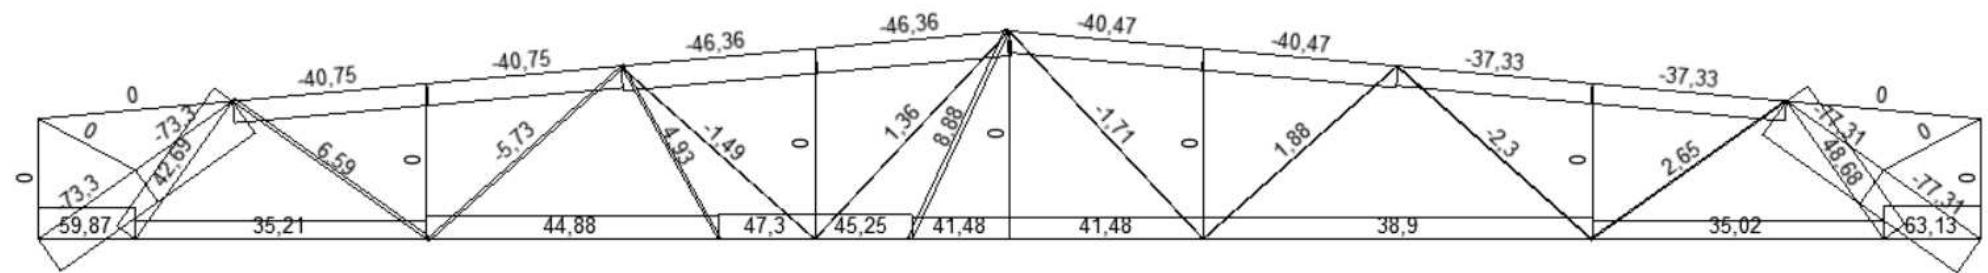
Эпюра внутренних усилий от третьей комбинации крановой нагрузки
